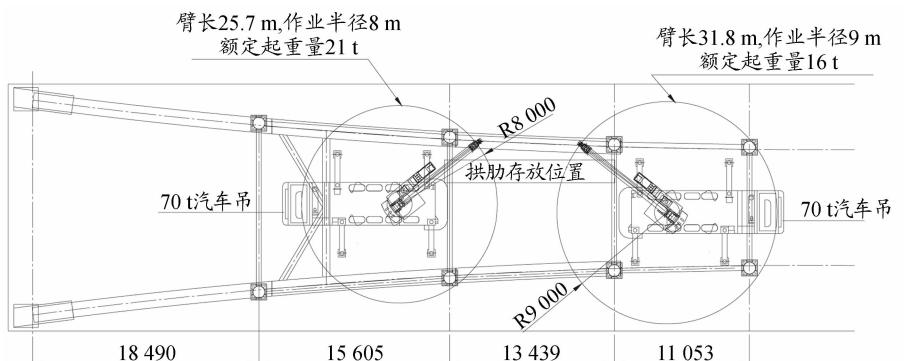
基于二维CAD图纸的施工现场模拟(单位:mm)
